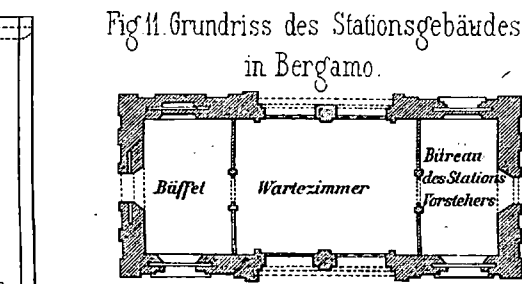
Grundriss des Stationsgebäudes in Bergamo.
